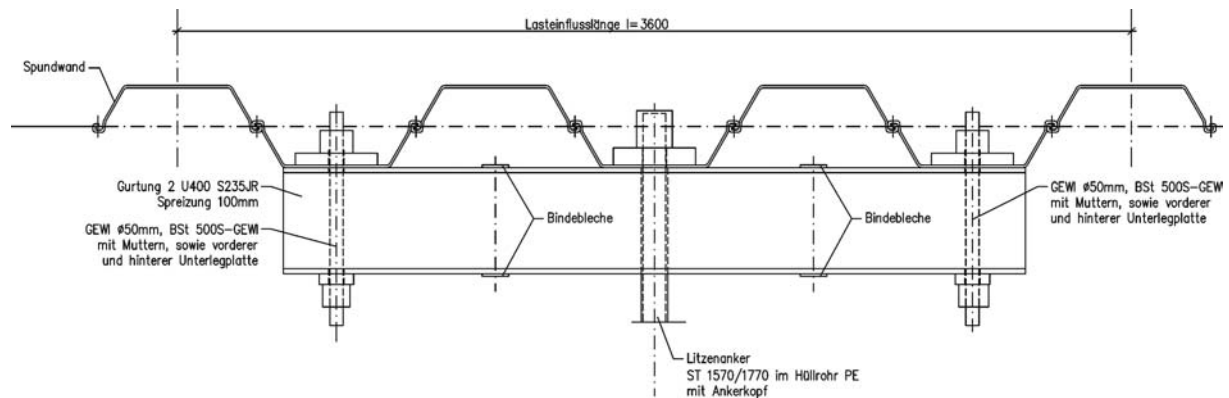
Darstellung der Detailausbildung zur Rückverankerung der Baugrubenwand mit erdseitiger Gurtung
